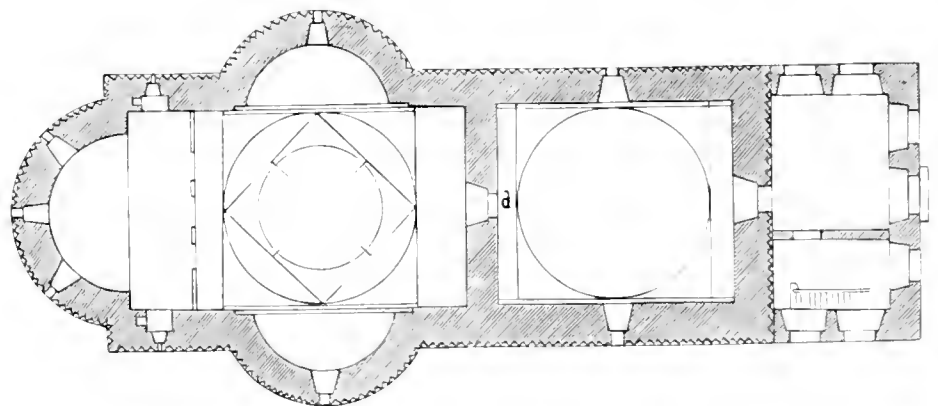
(Johannes-Kirche in Sereth, Grundriss)
